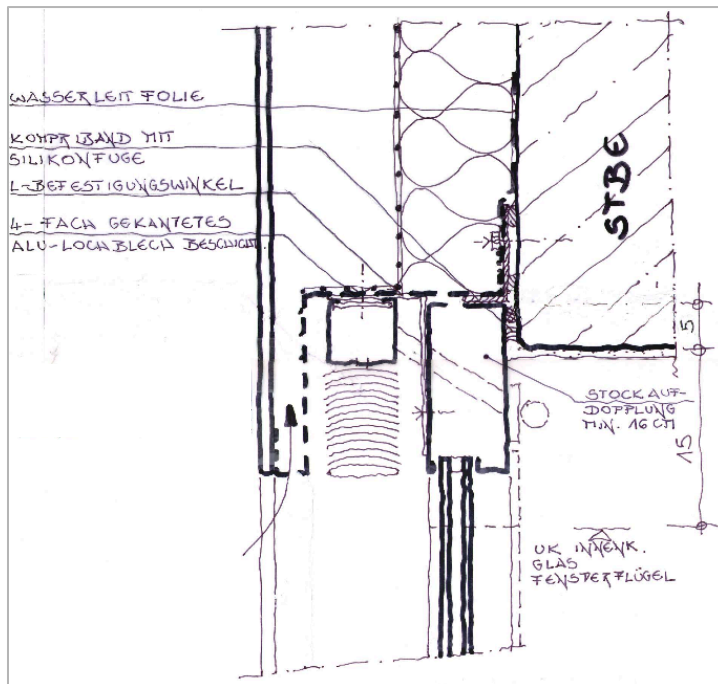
Fensteranschluss im Sturzbereich inklusive vorgehängter Fassade (Zeichnung Arch. Zinterl)
